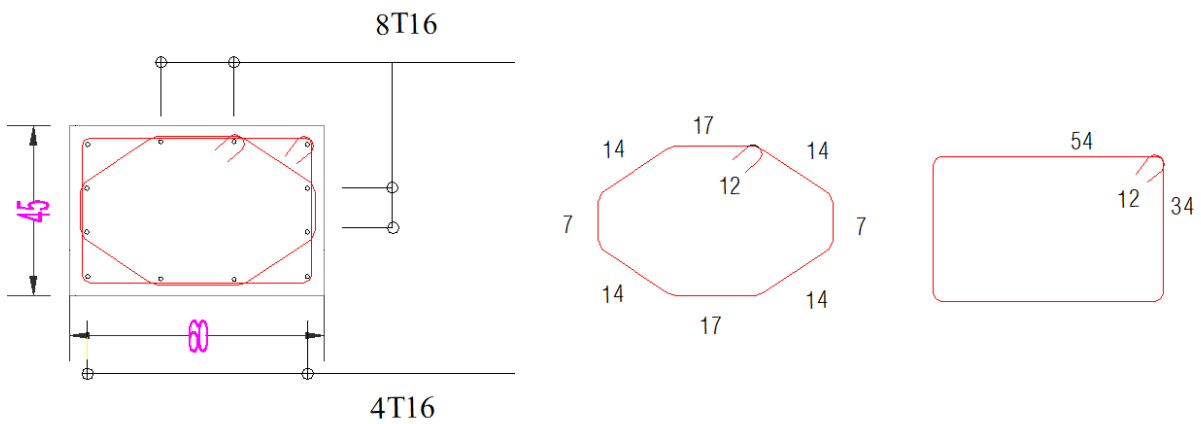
Schéma de ferrailage des poteaux R (45 x 60)
